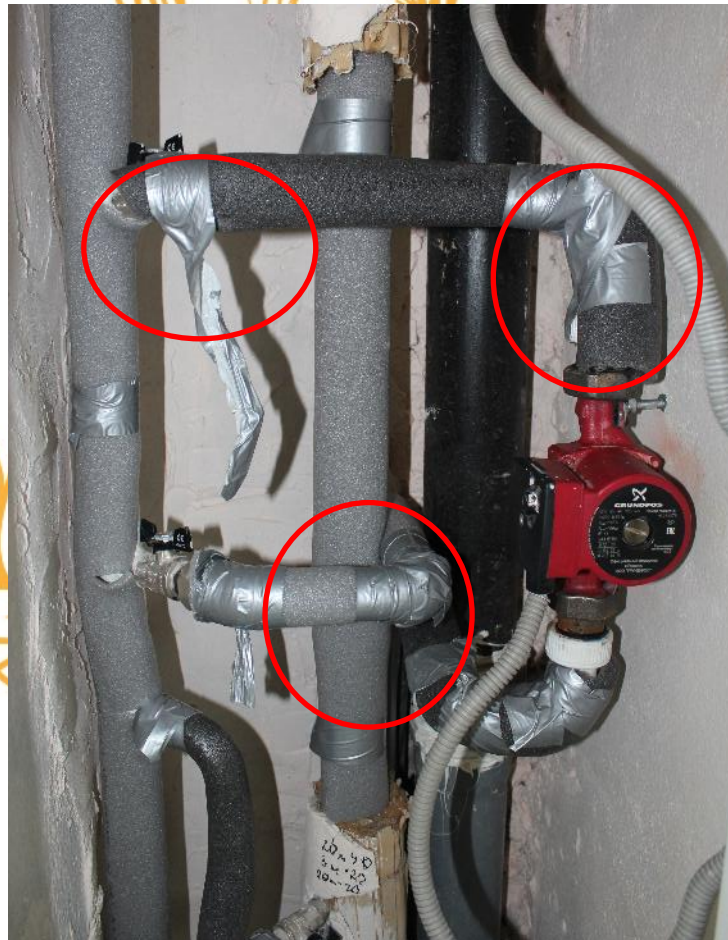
Не качественно выполненный монтаж теплоизоляционного покрытия.
